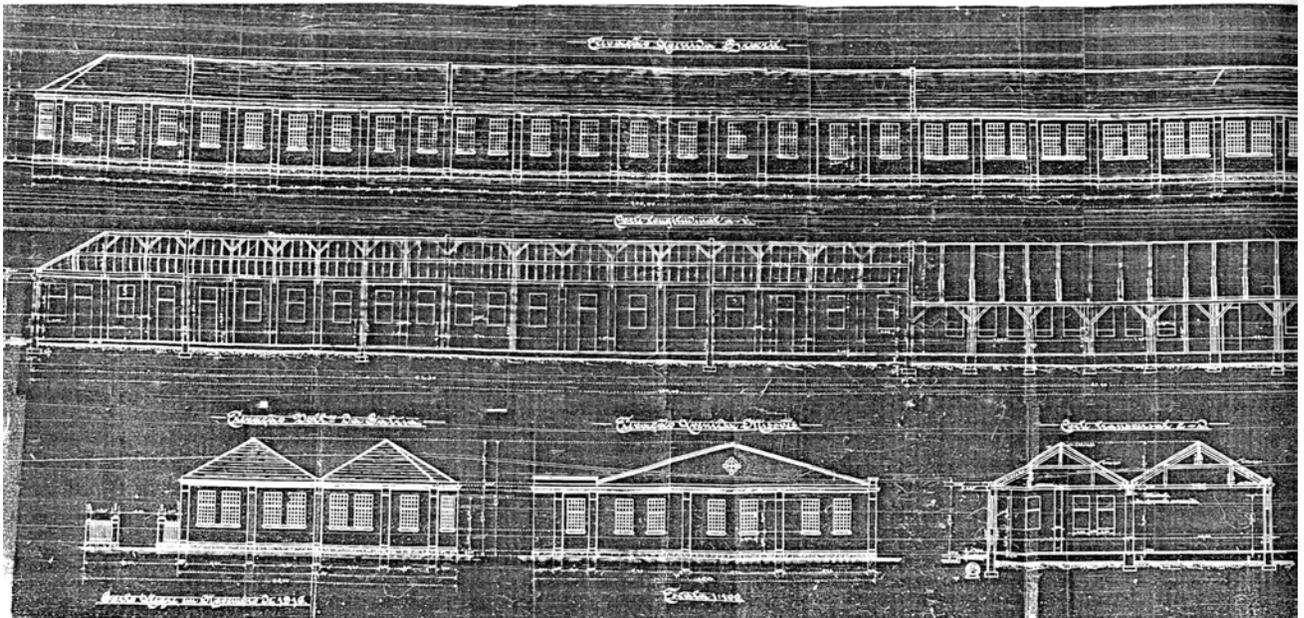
Cortes e fachada do bloco 1, Móveis Gerdau, T. Wiederspahn, 1916.
